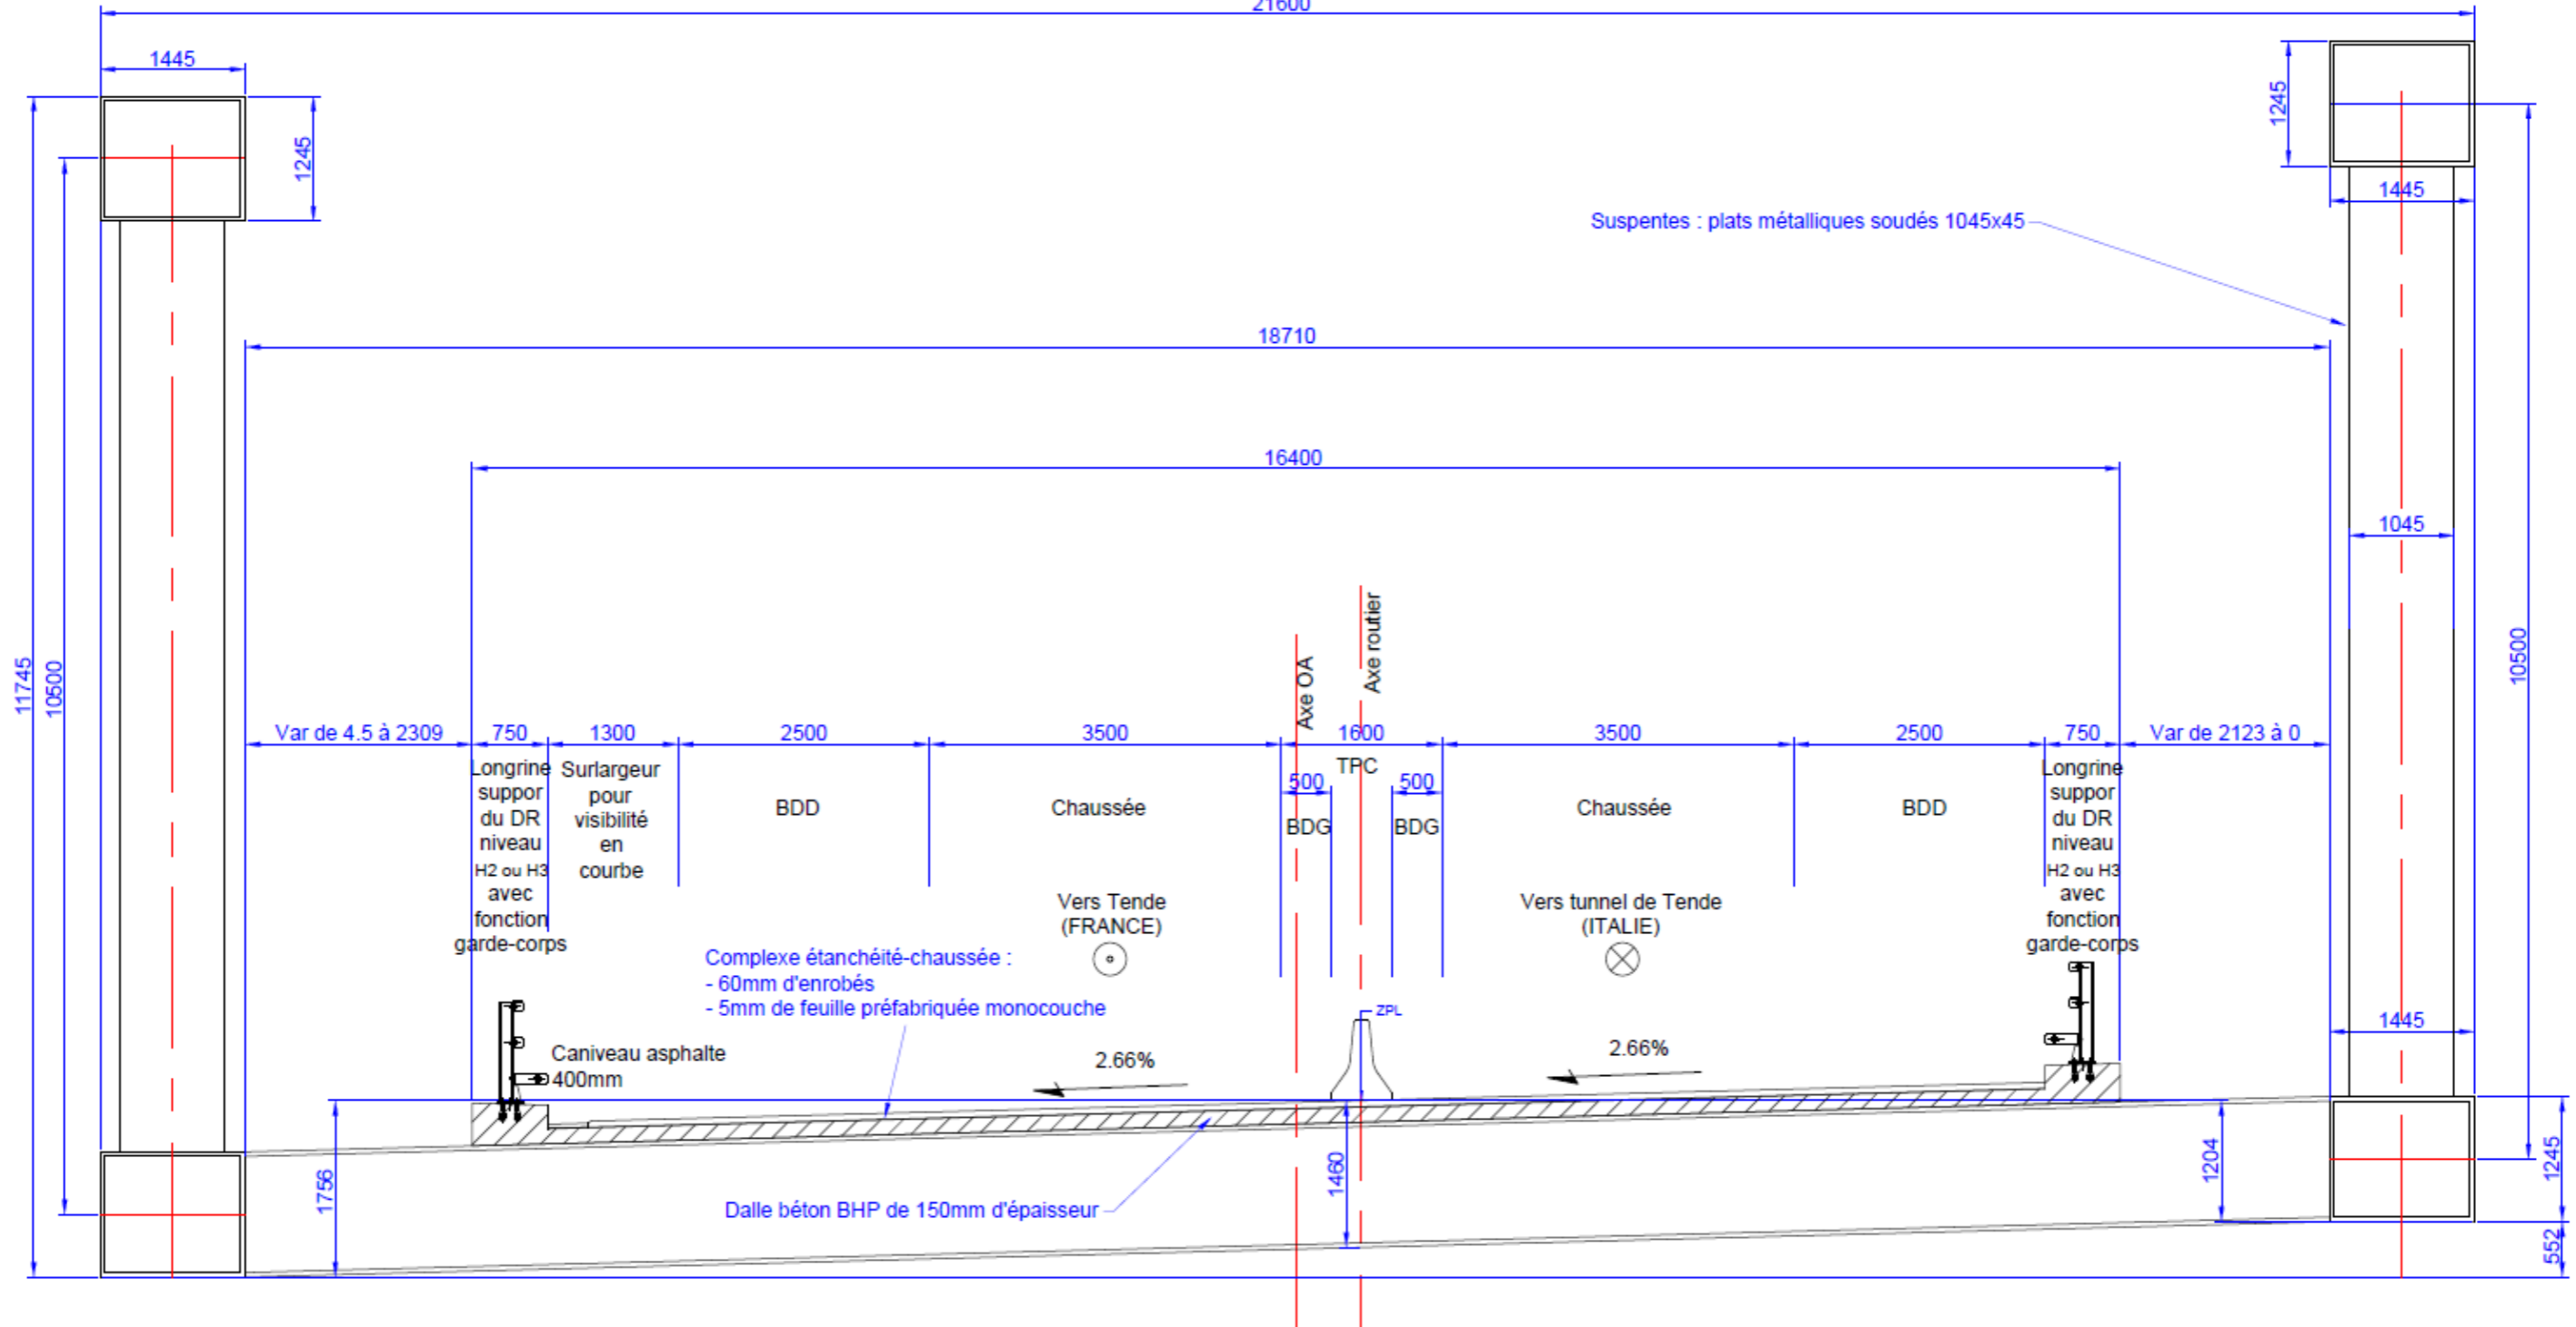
Struttura unica: sezione trasversale a metà campata della struttura
